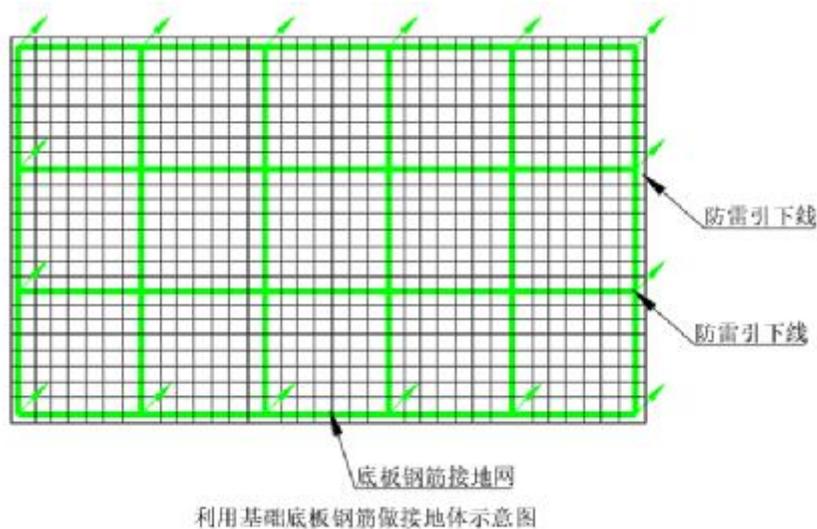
利用基础底板钢筋做接地体示意图
